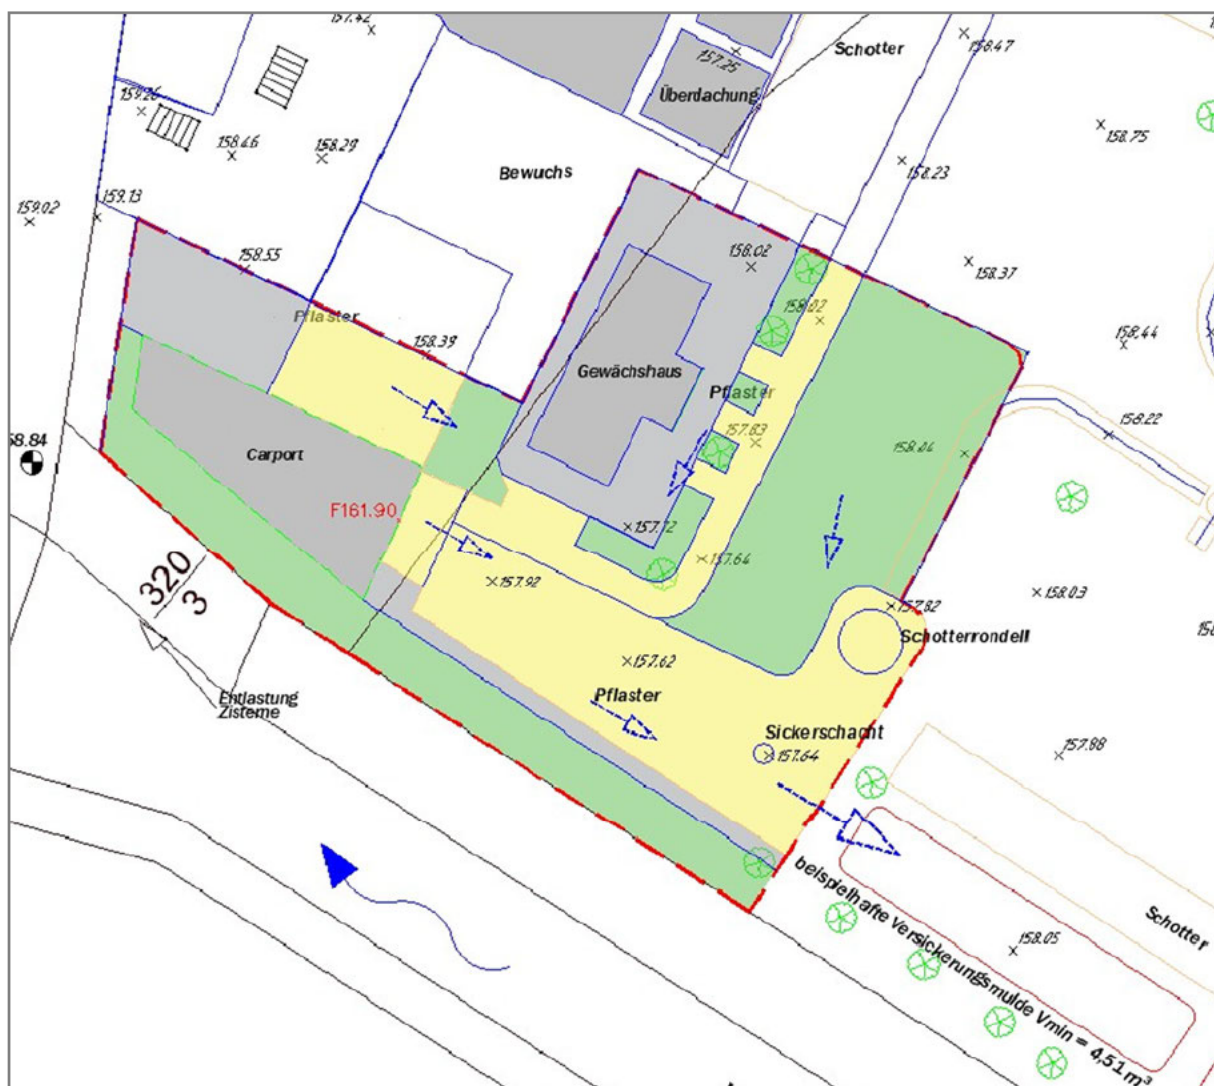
Neue bebaute Flächen (Einzugsgebiet 2) mit bestehendem Anschluss an Sickerschacht [5]
